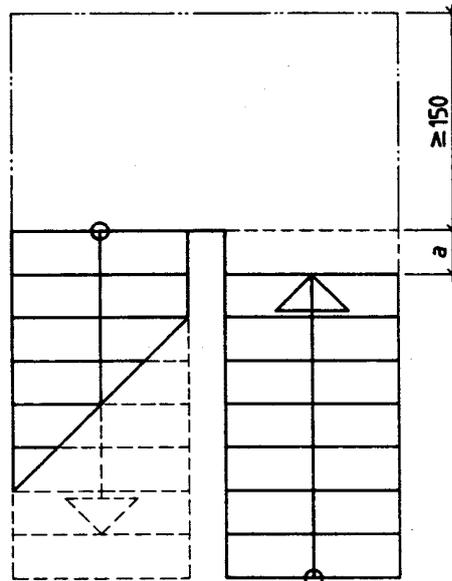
Bewegungsfläche neben Treppenauf- und -Abgängen
